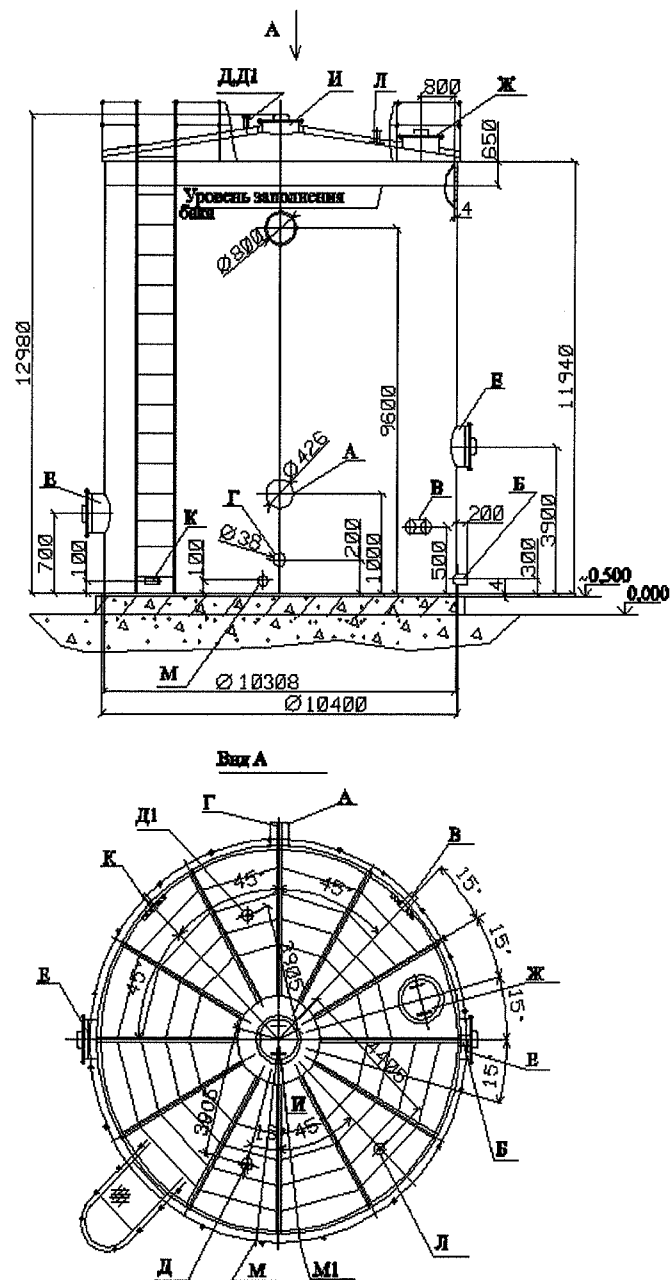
Габаритный чертеж баков 00LDT10BB001, 00LDT10BB002
